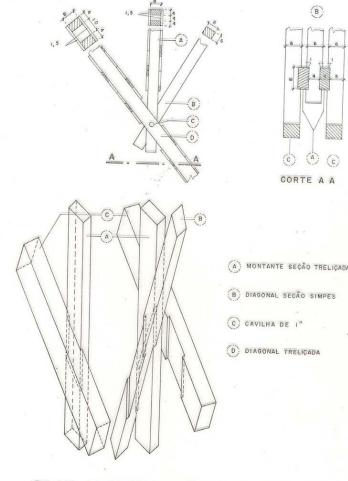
DETALHE DA LIGAÇÃO DO NO 17 DA TRELIÇA 'A' LEVANTAMENTO-CÉSAR, S.E.
